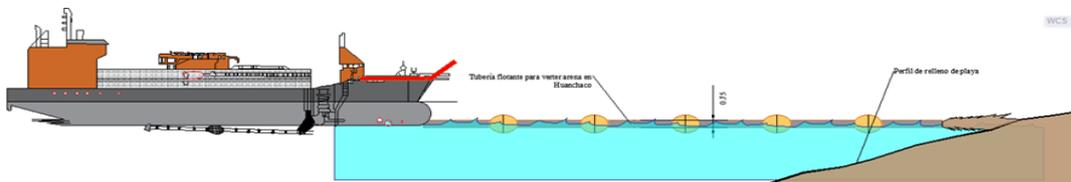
Conducción de material a través de tuberías flotantes hacia las zonas de relleno de playa.
